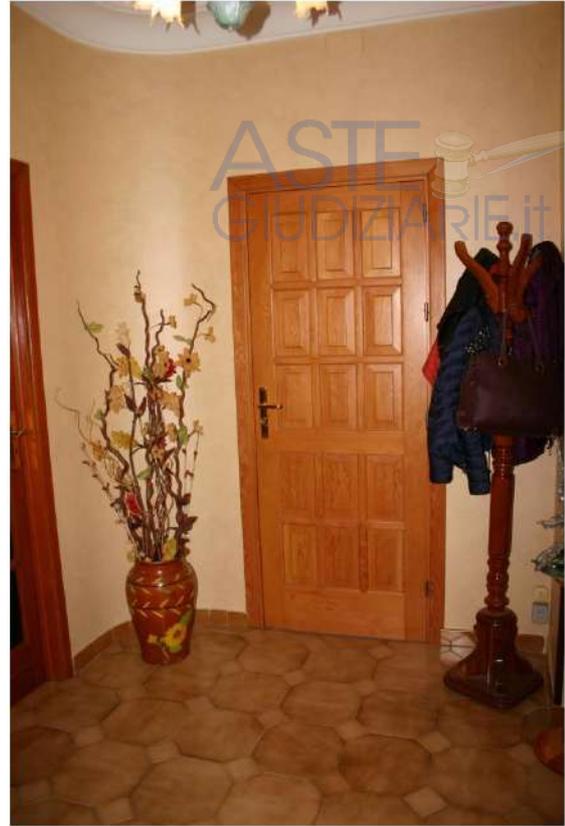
LOTTO 2 via Giordano Bruno 19 P.1° Mussomeli fg. 42 part. 662 sub 3 -Ingresso
